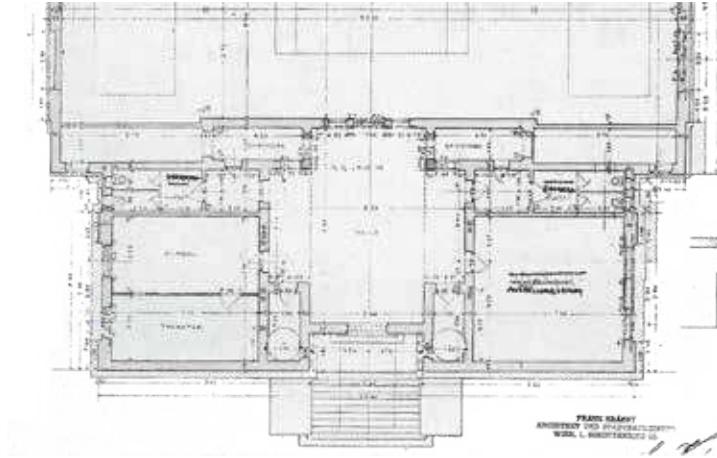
Grundriss Erdgeschoss Ausführung Maßstab ca. 1:350
